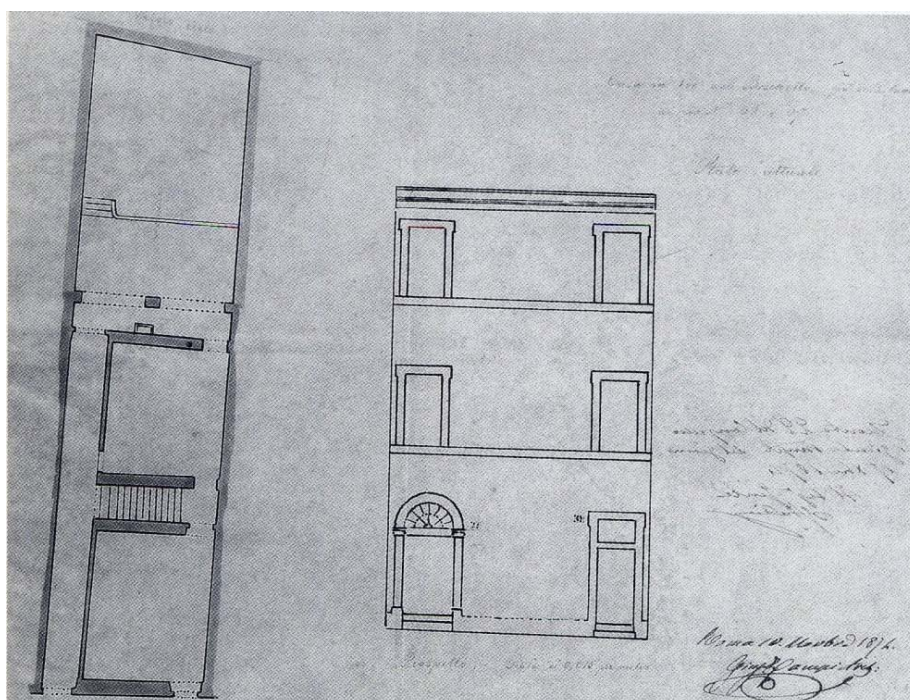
Pianta e prospetto di una casa a schiera in via del Boschetto (da TIBALLI 1991)
